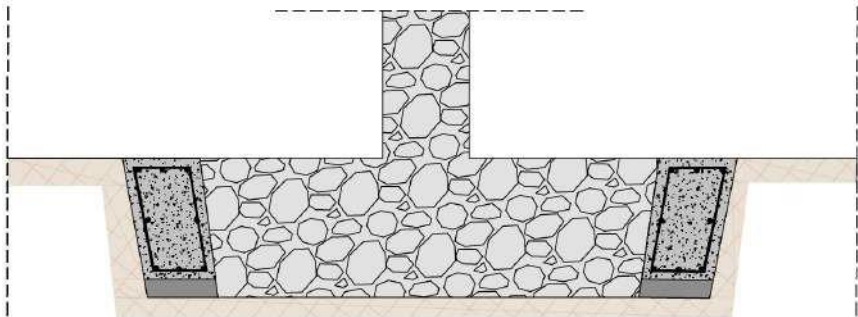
Sección zapata aislada. Refuerzo Tipo 2. Fuente propia
